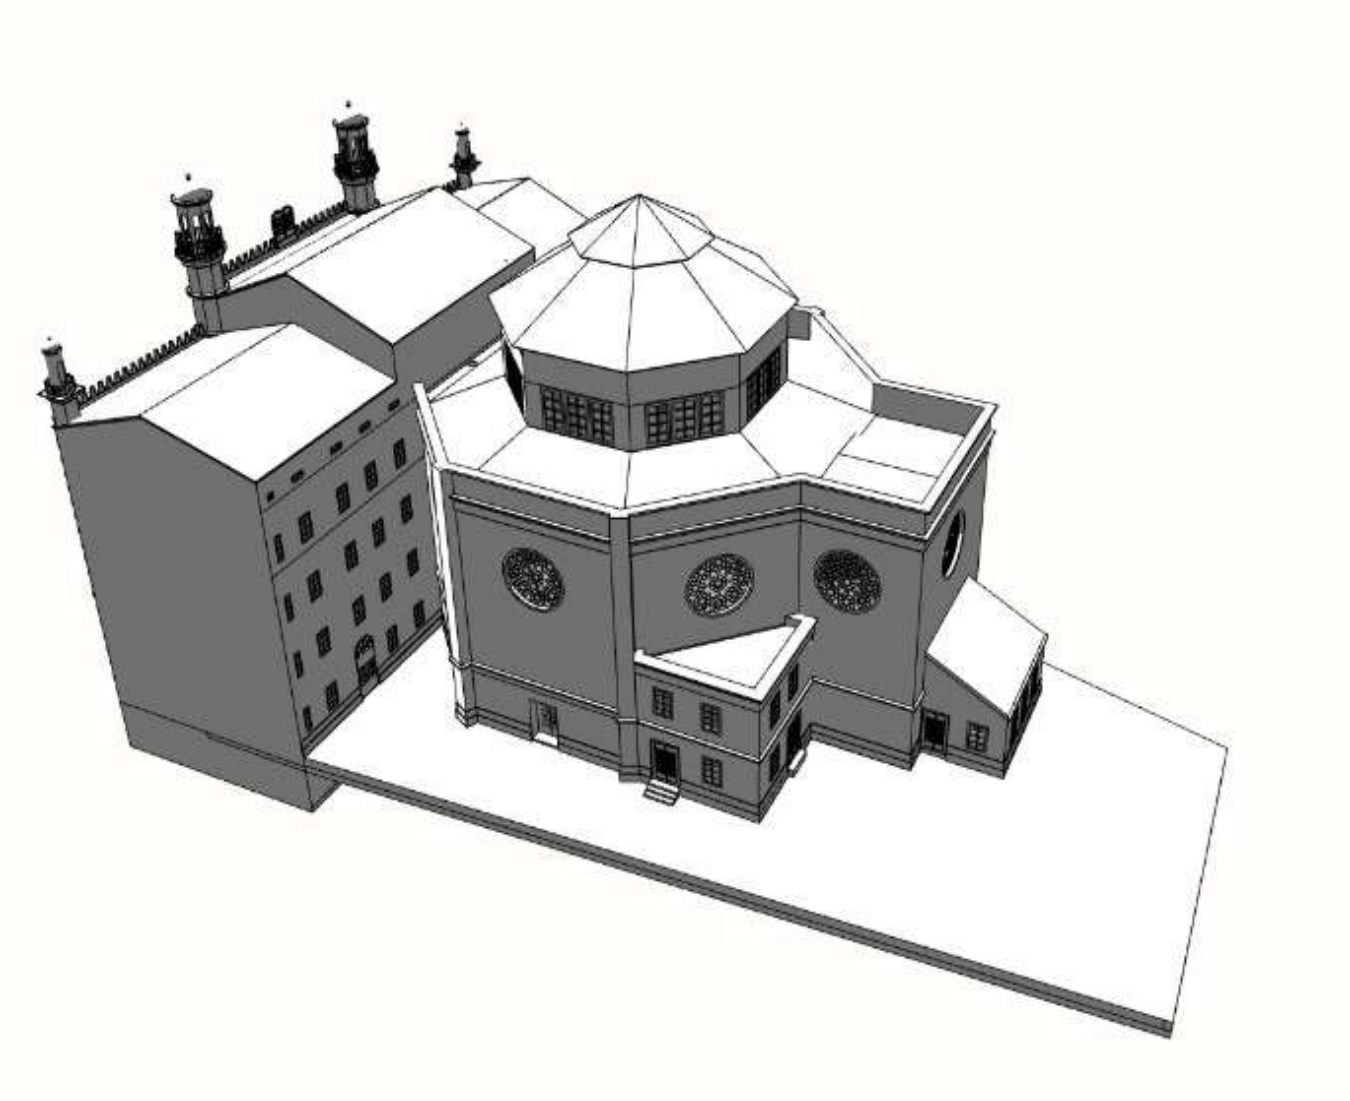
3D Rekonstruktion, Dachdraufsicht Modelldarstellung
